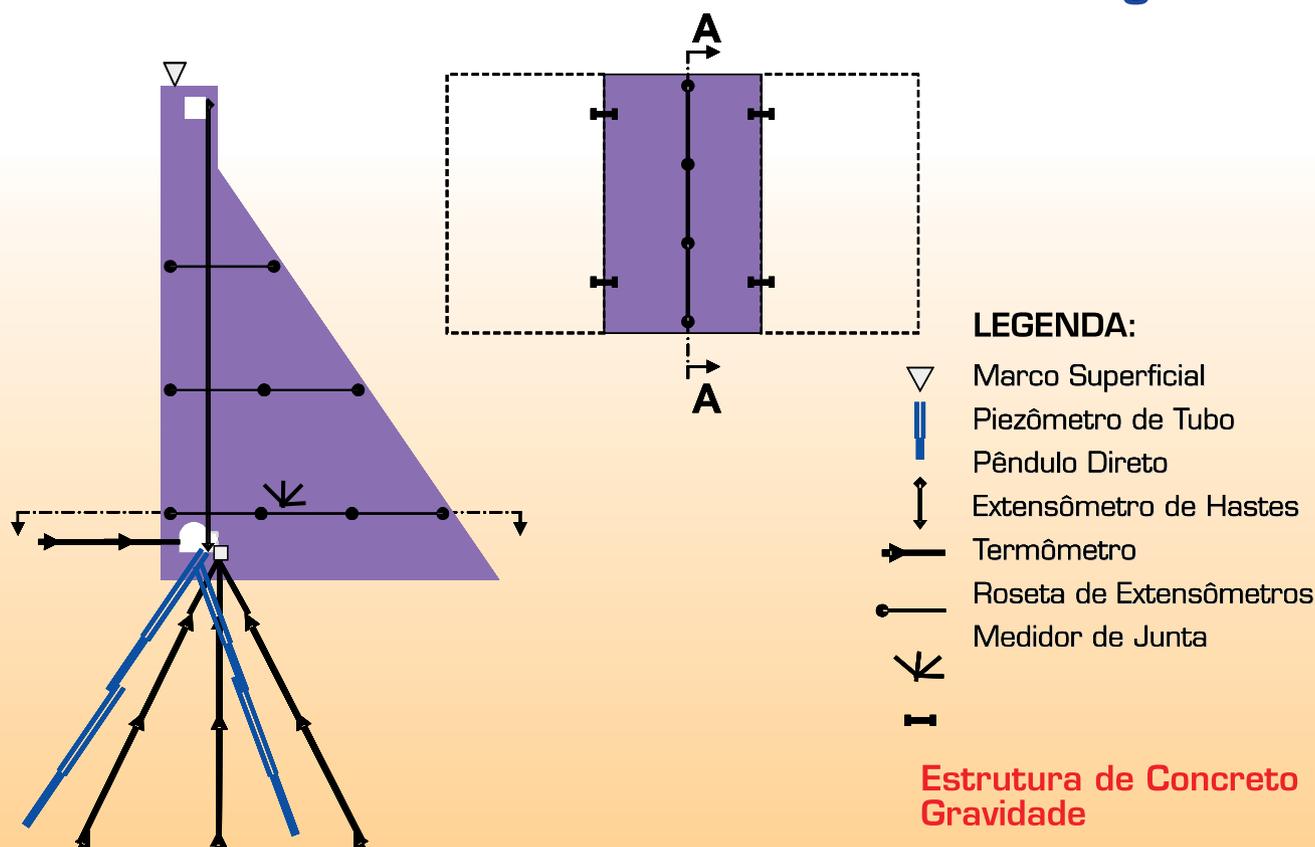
Seção típica de uma barragem de gravidade instrumentada
